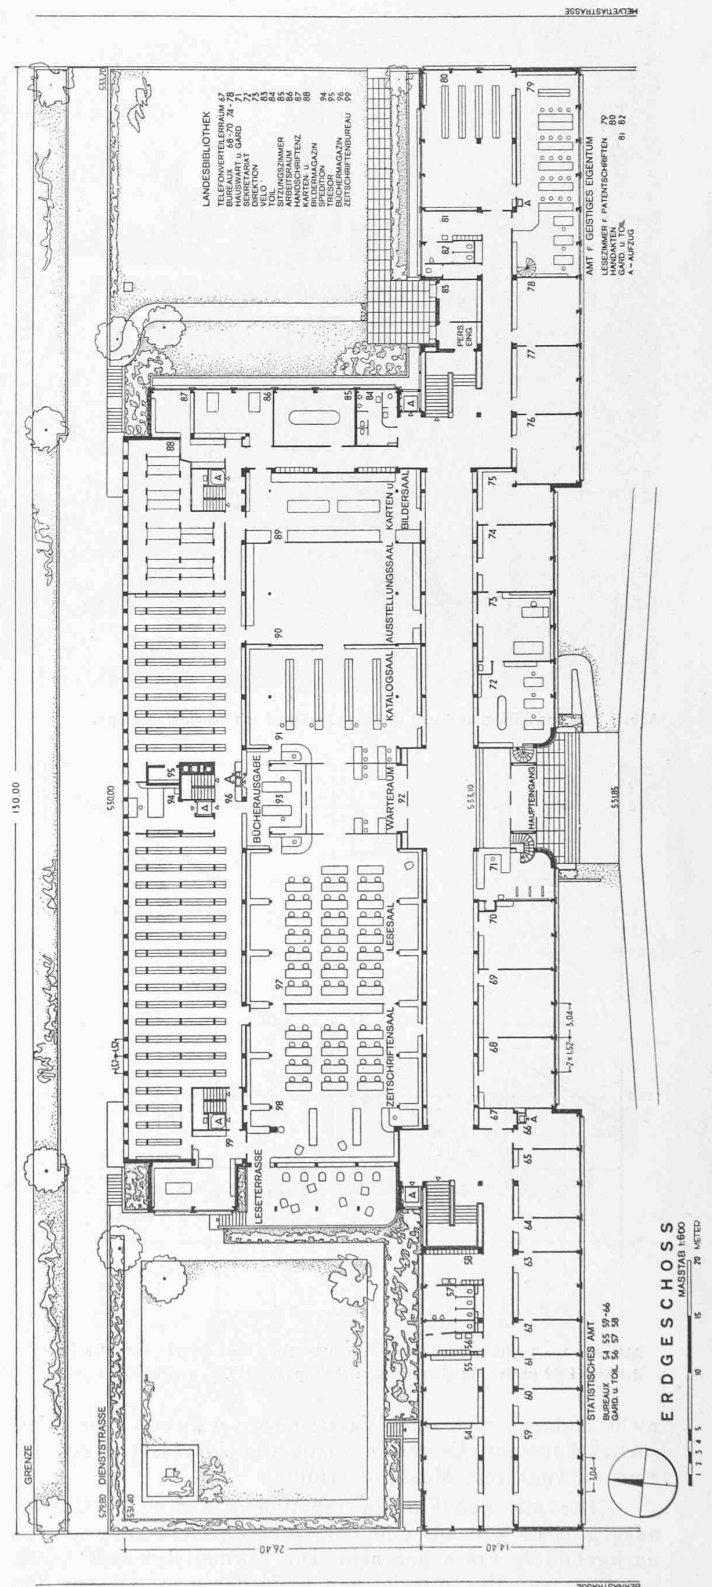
Erdgeschoss-Grundriss. — Masstab 1 : 600.
